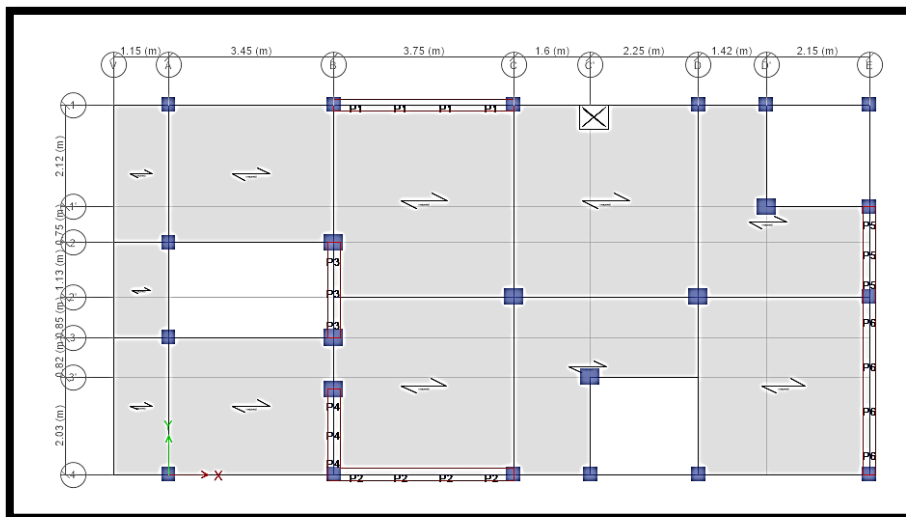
Vista en planta del plano de estructuras – 1er piso en ETABS
